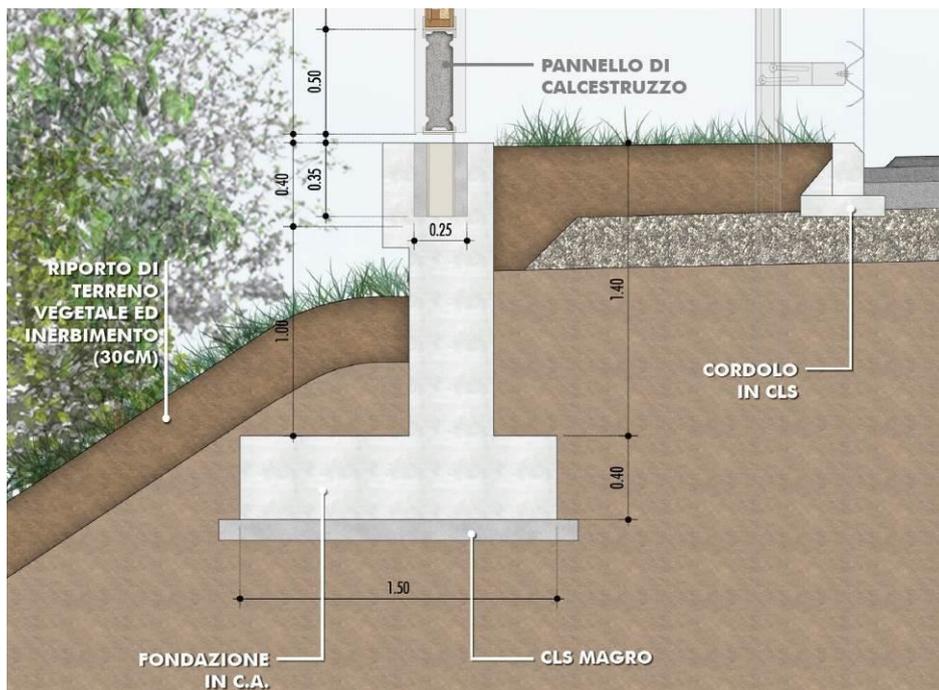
TIPOLOGICO DEL SISTEMA DI ANCORAGGIO E DELLA FONDAZIONE
